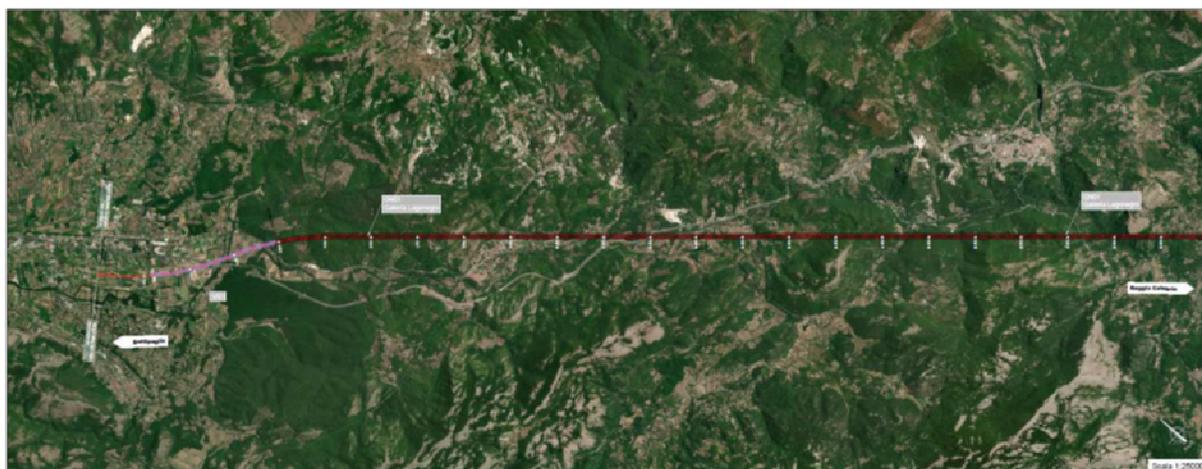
Planimetria di progetto stazione di Buonabitacolo
